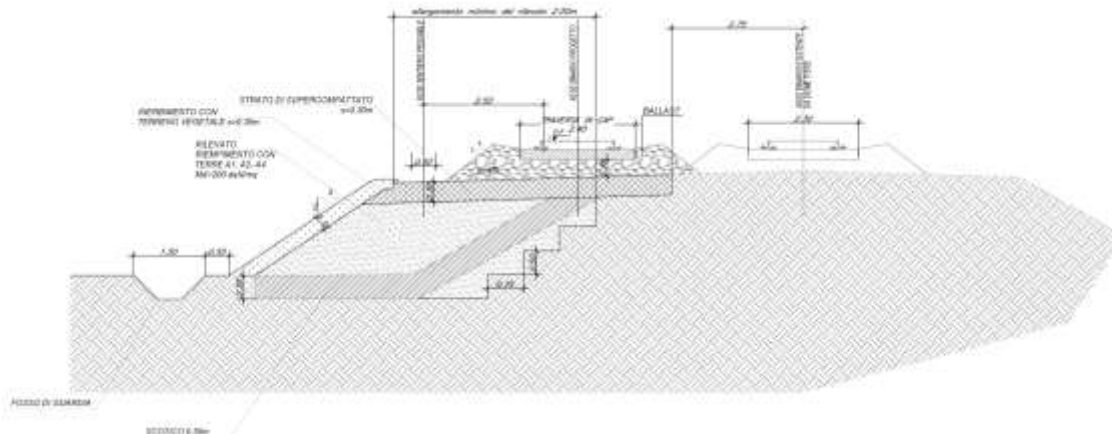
Sezione tipo in rilevato a SB, tratto in ammassamento al corpo stradale esistente
